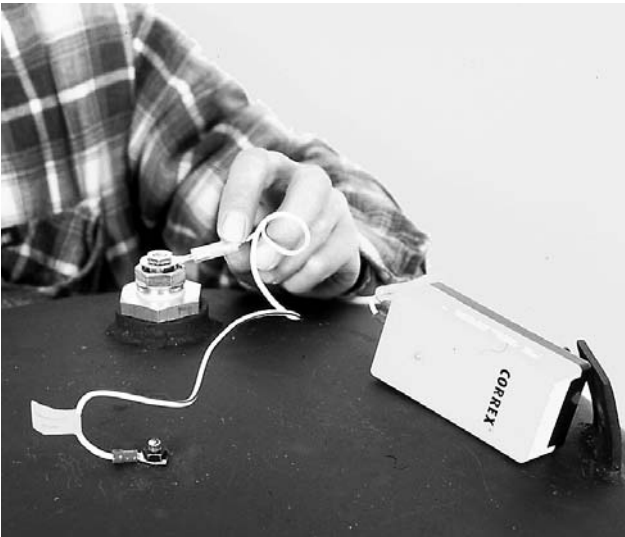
Option: Vom Elektronikgerät ein Kabel an Erdungsschraube befestigen und das andere auf die Elektrode stecken.
